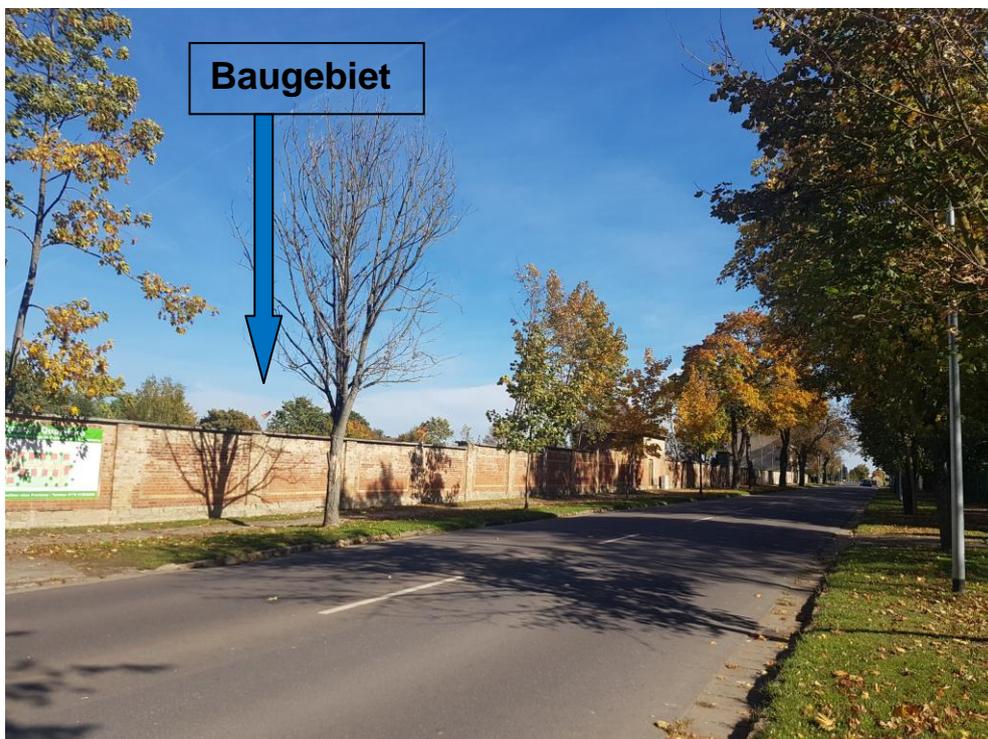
Ansicht von Südwesten (Hauptstraße) auf das eingefriedete Plangebiet
